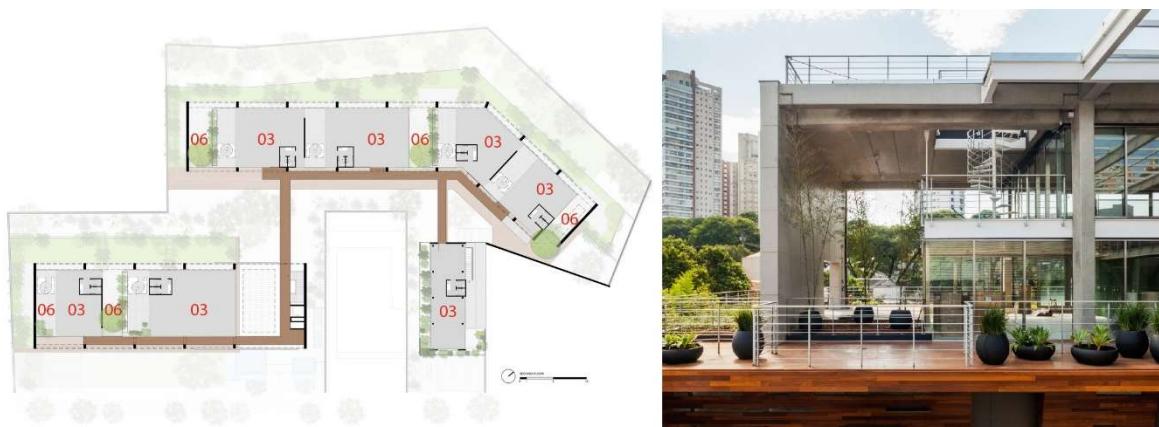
Planta Baixa 2º Pavimento (03 – Escritórios | 06 – Varandas privativas).
